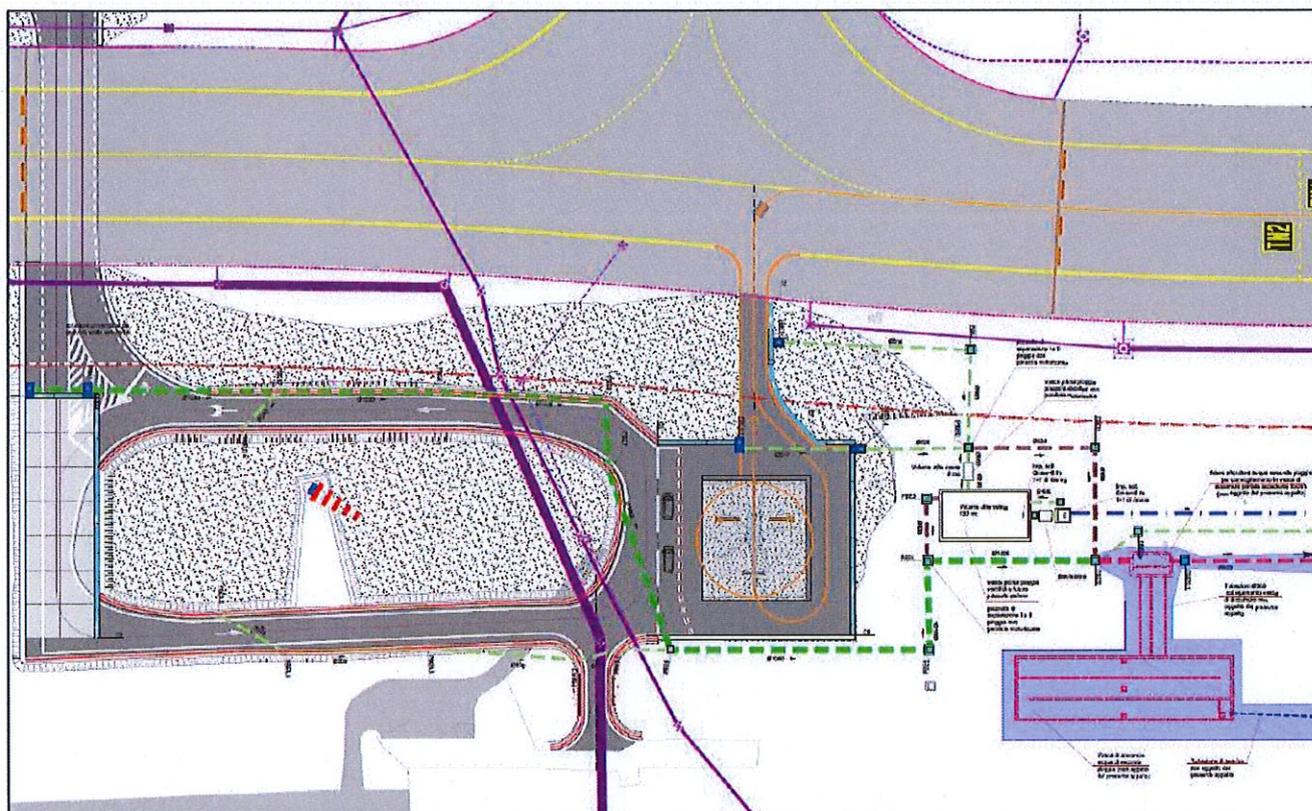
Sistema di drenaggio piazzola elicotteri (in magenta la rete di drenaggio esistente). L'area coperta dal retino magenta indica le opere del sistema di drenaggio che non sono oggetto del presente appalto.
